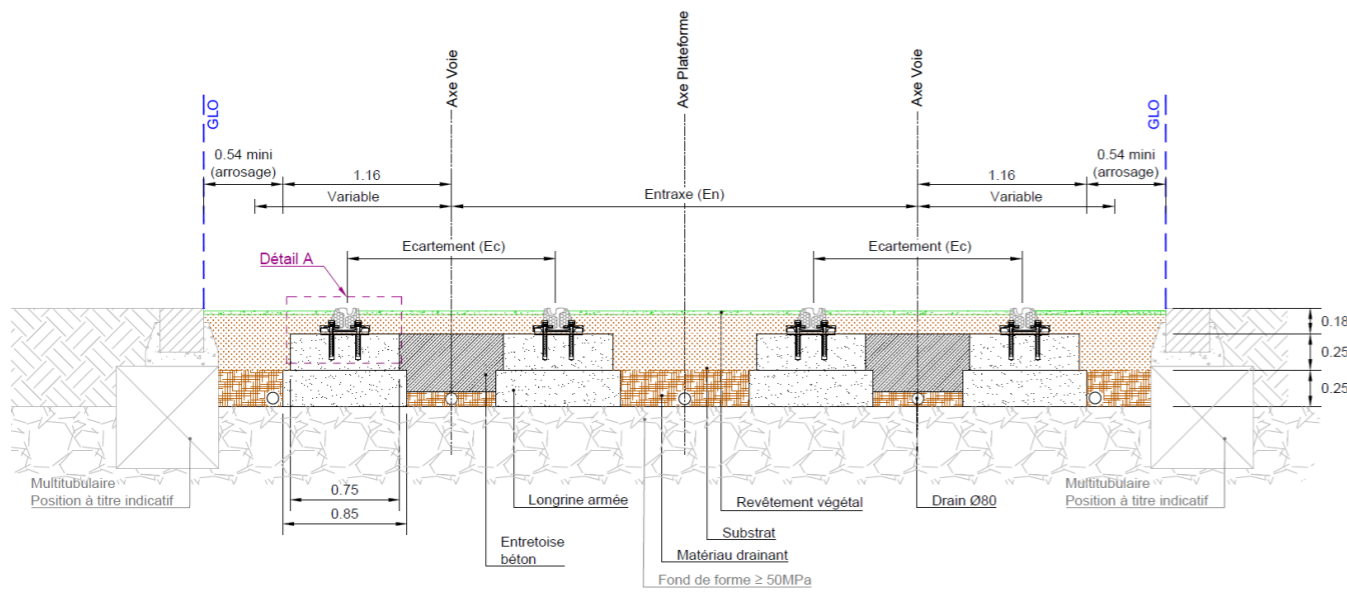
coupe type d'une plateforme pour voie sur longrines - Revêtement végétal
